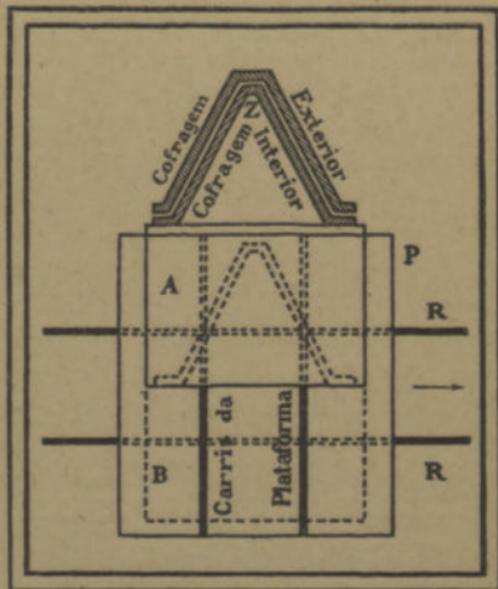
Vista em planta da plataforma de cimento armado que serviu para construir a abóbada até uma altura de 17 metros.
